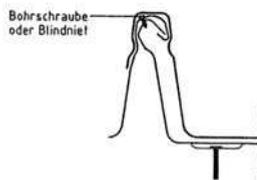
Befestigung der Klemmfalzprofile mit Klemmbügeln auf der Unterkonstruktion
